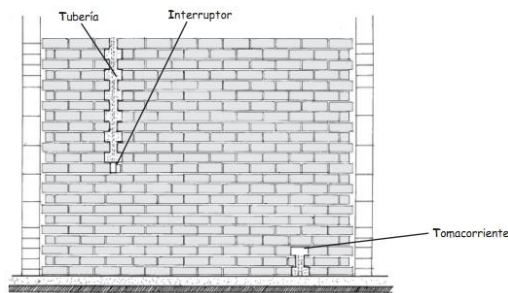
Instalación eléctrica en muros (Blondet, 2005).
